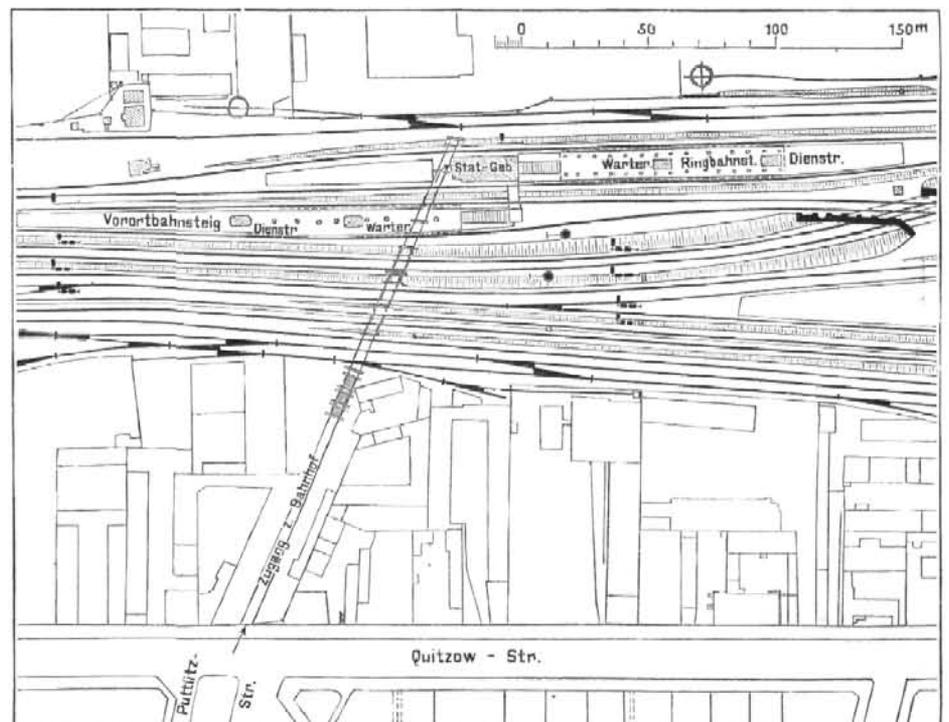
Bahnhof Putlitzstraße. Lageplan.
